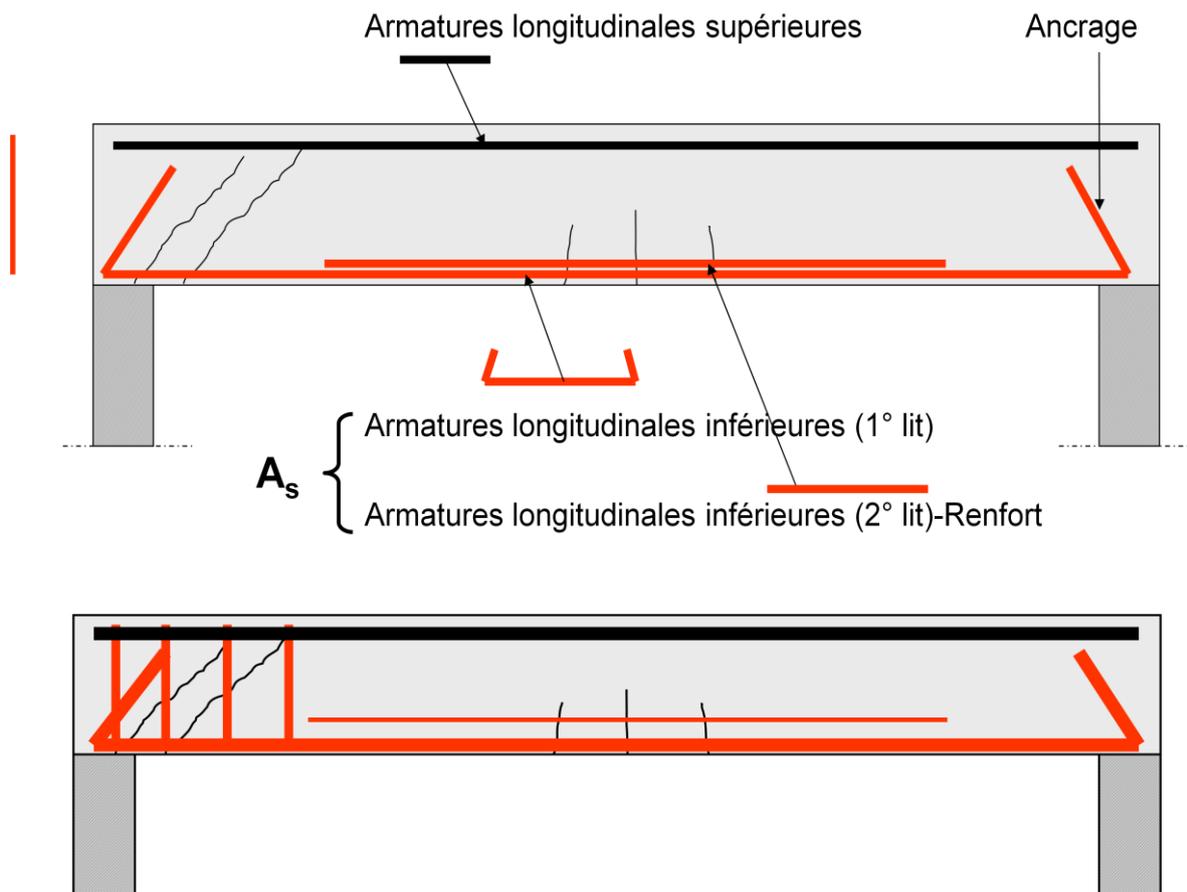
La représentation des armatures dans une poutre en Béton armé [17]
